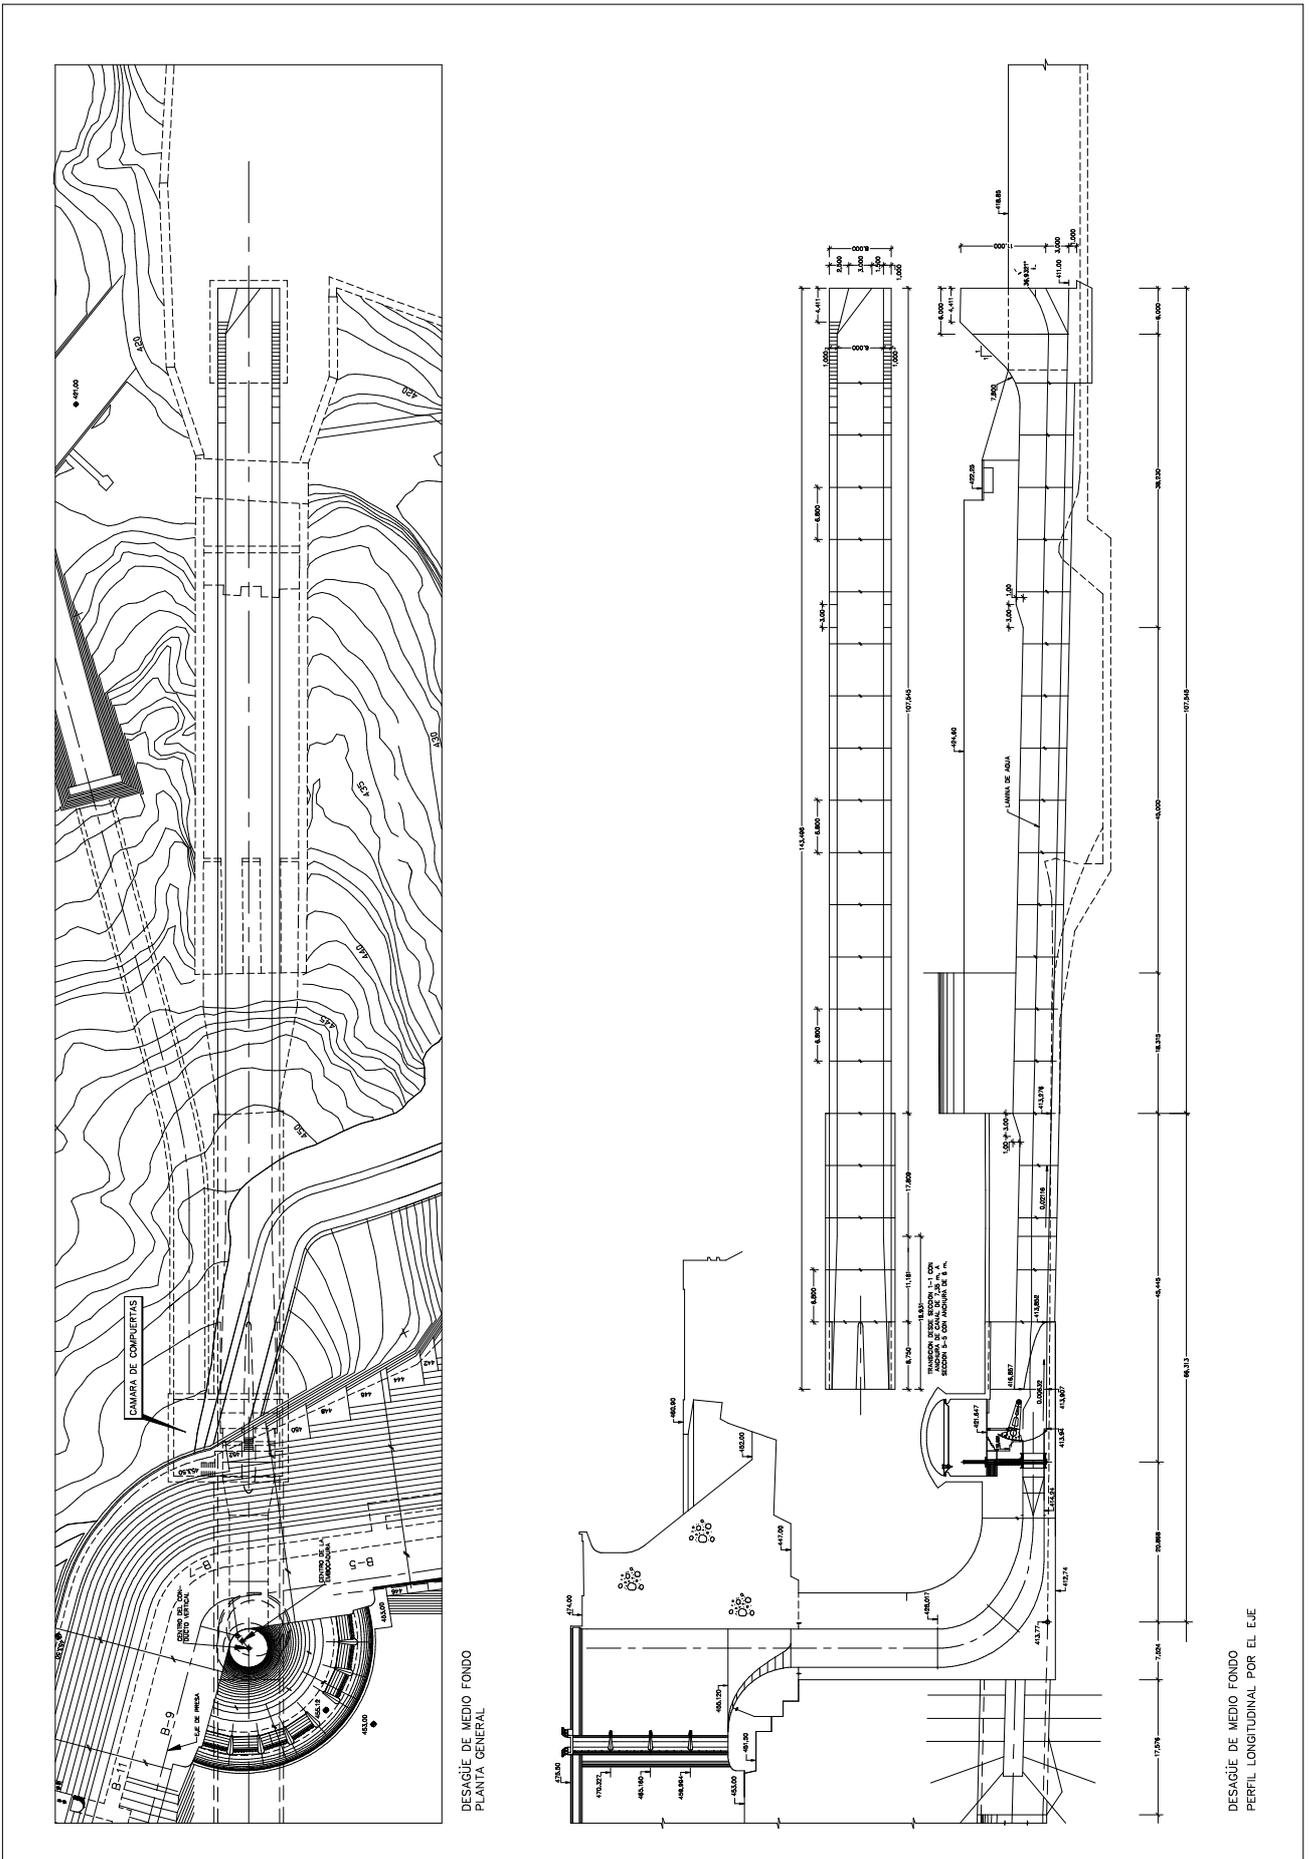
Desagüe de medio fondo – Planta General y Perfil Longitudinal
